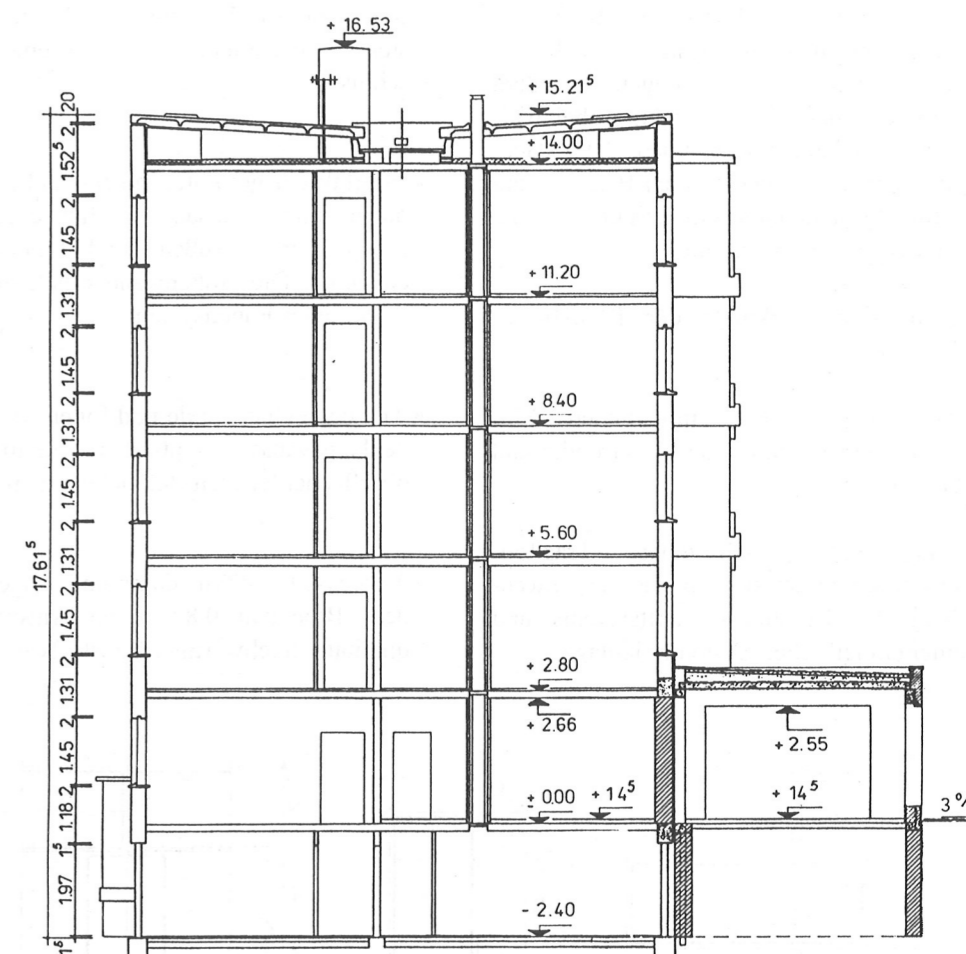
Querschnitt durch ein Wohngebäude mit Funktionsunterlagerung Standort Hagenow
